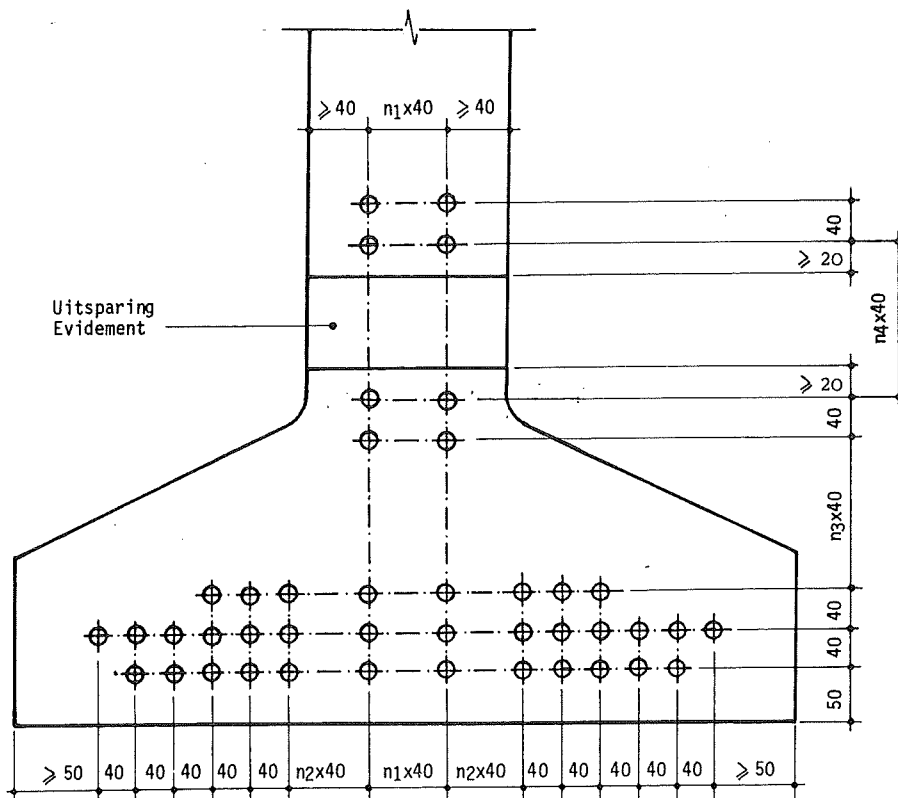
Disposition des torons dans une section profilée. (dimensions en mm)
